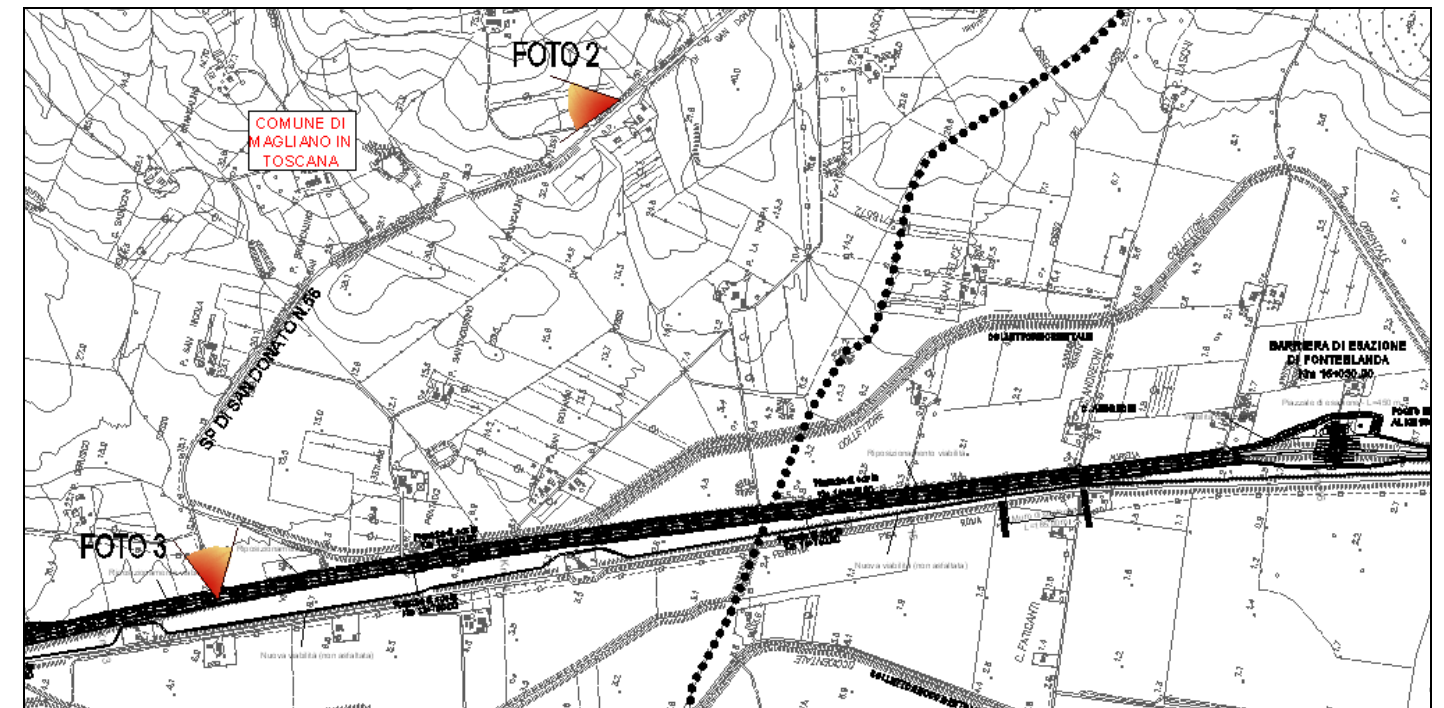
Stralcio planimetrico con individuazione dei punti di ripresa delle foto
